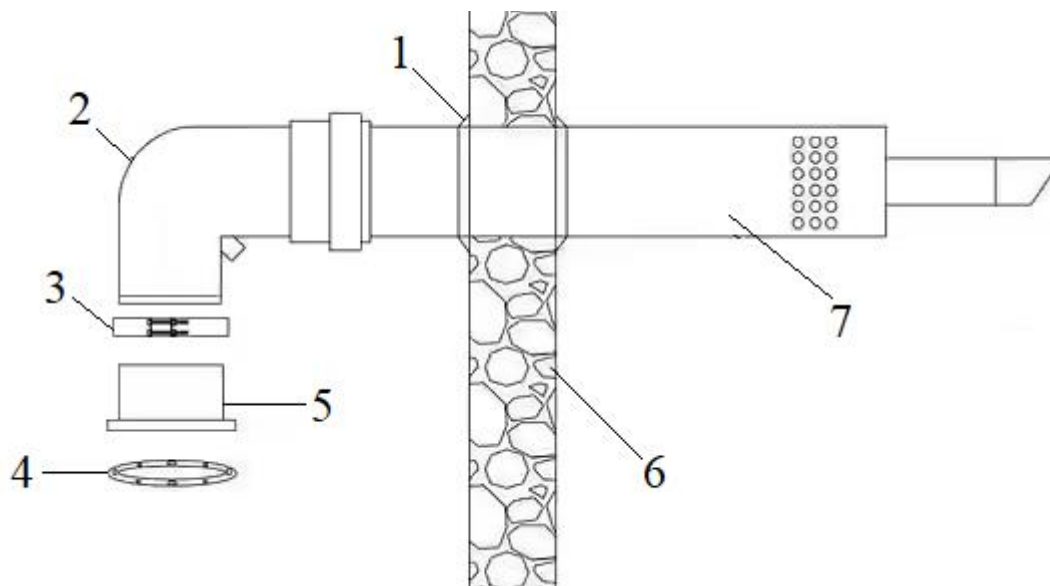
Схема сборки коаксиального дымохода для газового отопления с основными частями конструкции
